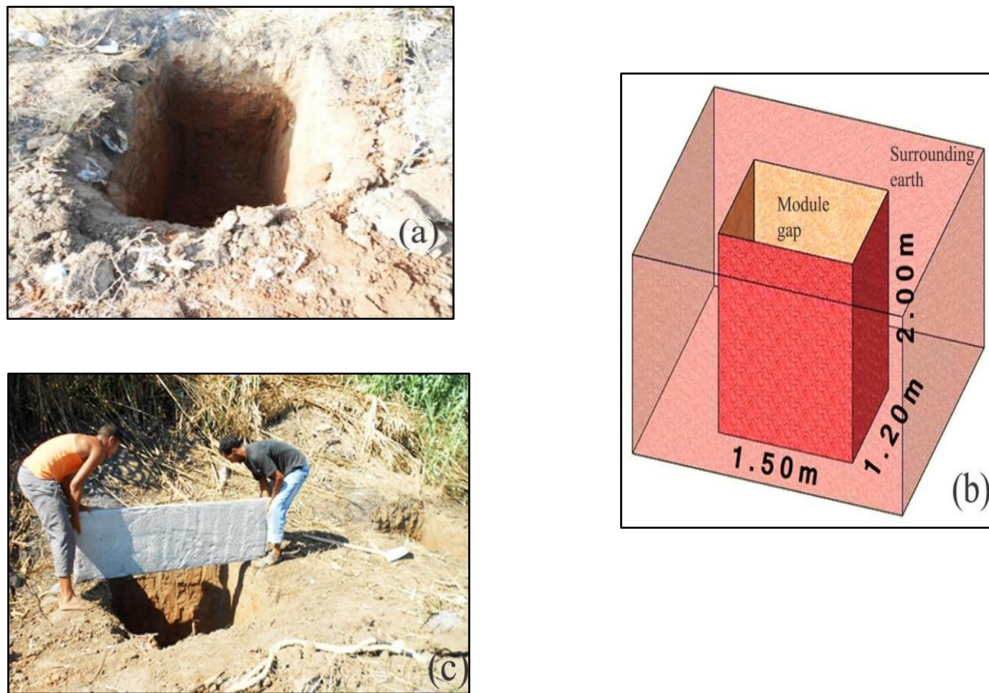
module sur site experimental : (a) module découvert, (b) volumétrie et dimensions du module, (c) : Installation d'une dalle préfabriquée en béton armé pour couvrir le module.
